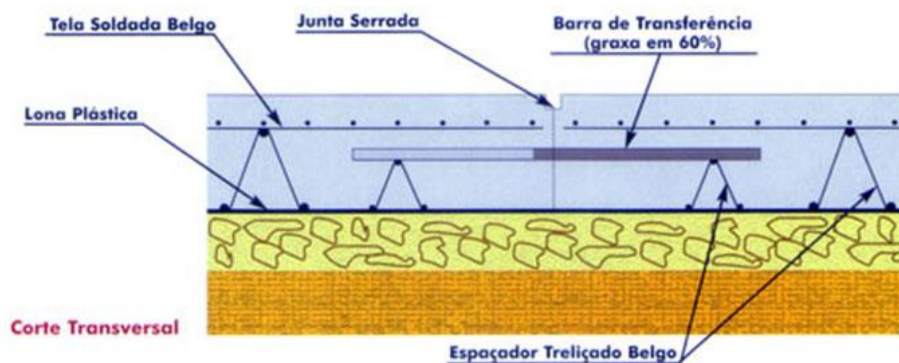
Detalhe de uma junta serrada e fissuração induzida
